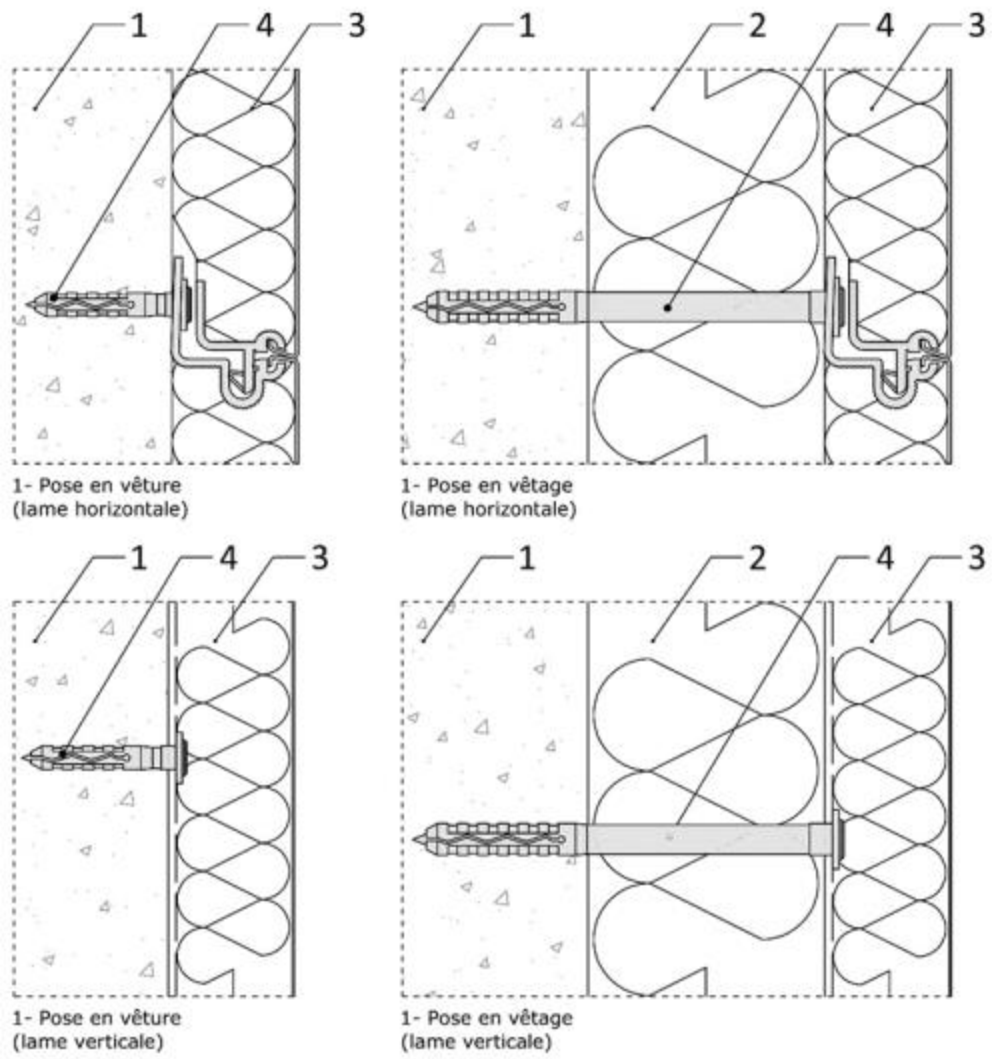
2 – Pose en vêtire (lames verticales) sur mur béton ou maçonné
